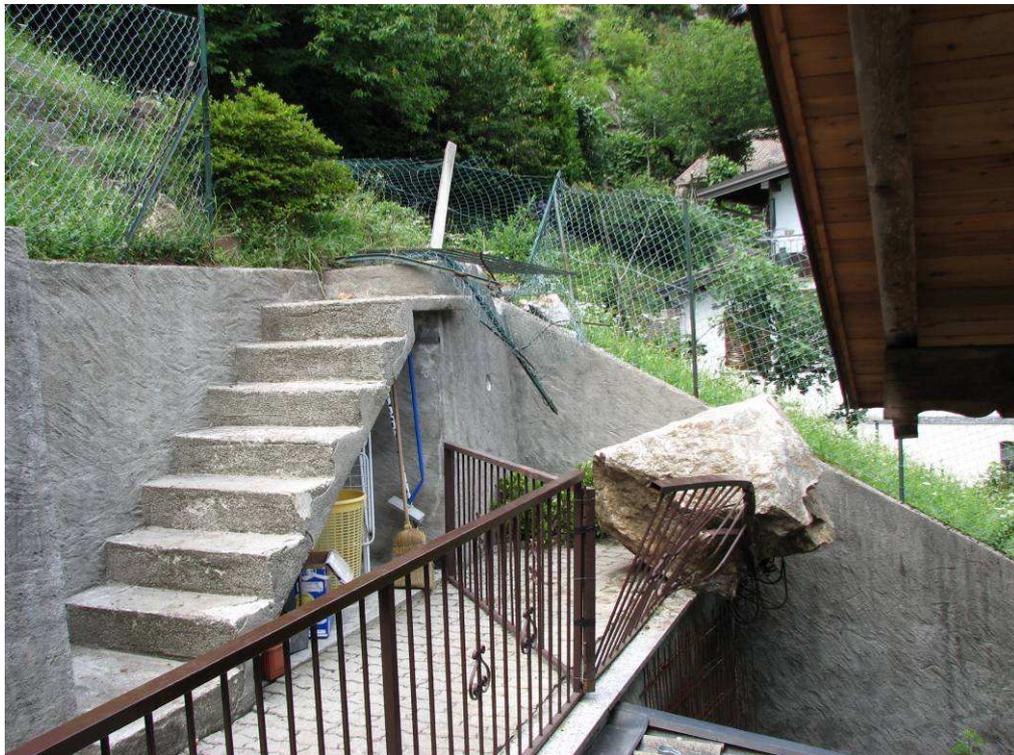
Masso fermatosi sul parapetto a ridosso dell'abitazione.
